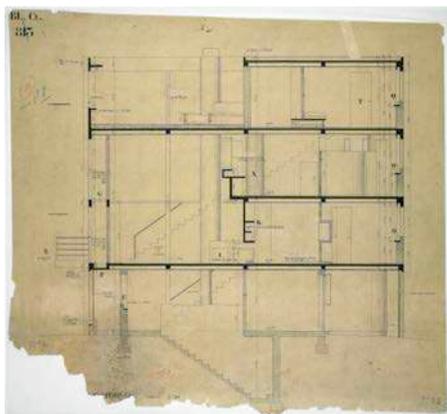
Detalle de elementos en hormigón, sección de la casa en Stuttgart (FLC 07792).
